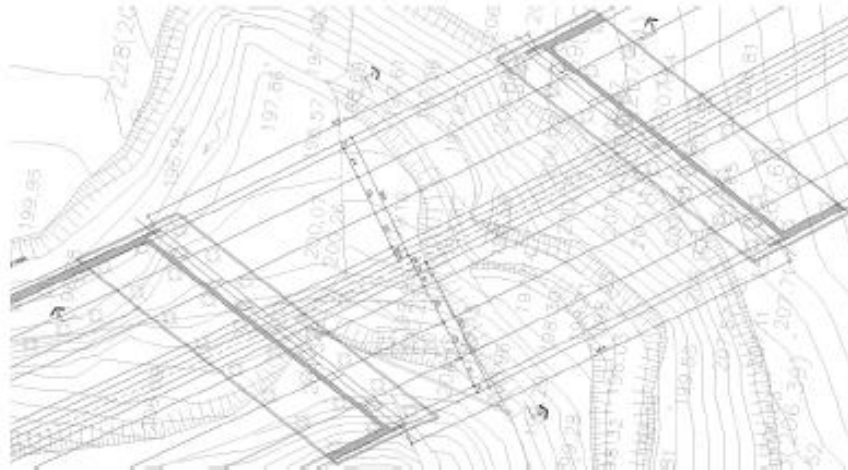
Ponte Rio dei Deglia: vista planimetrica.
